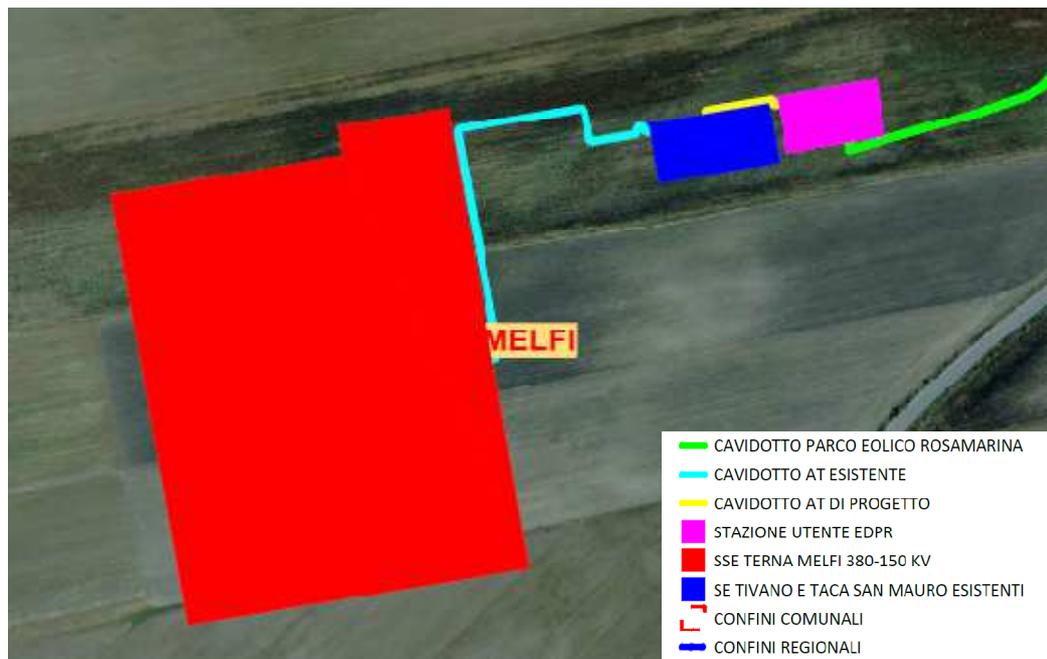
Stralcio planimetrico area sottostazione nel territorio comunale di Melfi in Località Masseria Catapaniello
